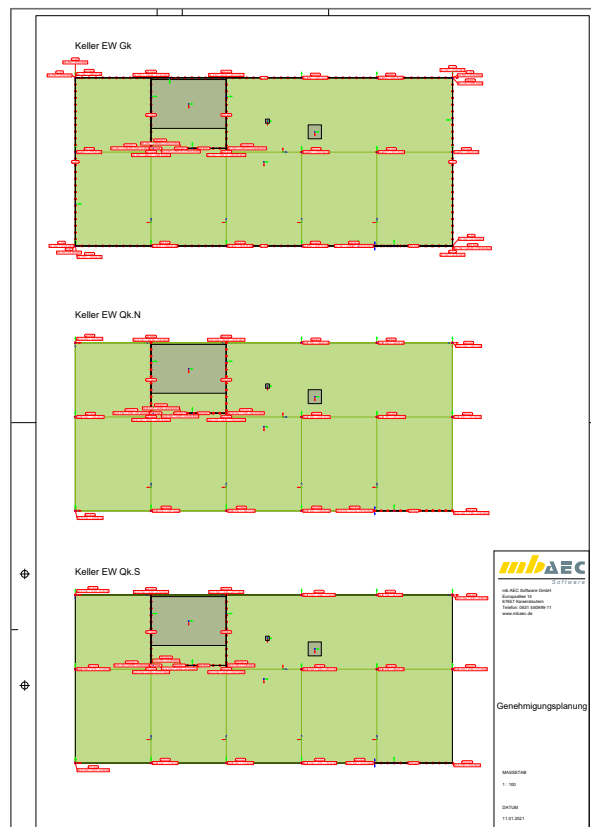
Beispiel einer Plansicht: Lasten auf eine Kellerdecke
